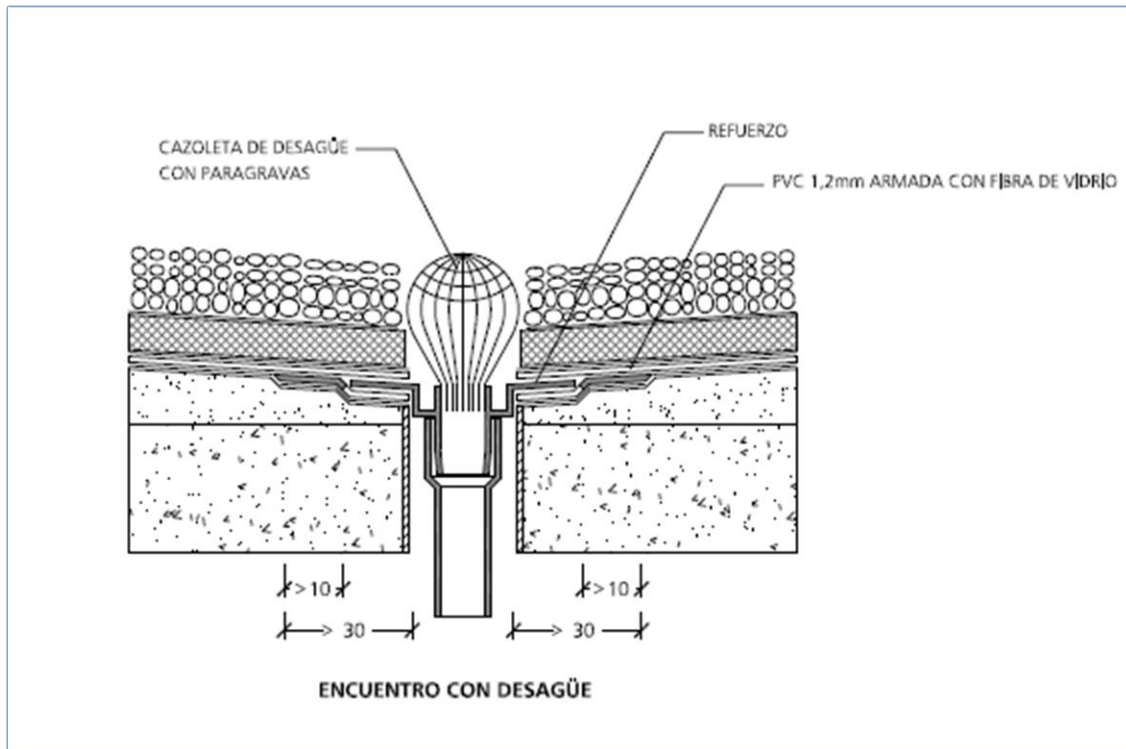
Ejemplo de encuentro entre cubierta y desagüe de bajantes en depósito existente
